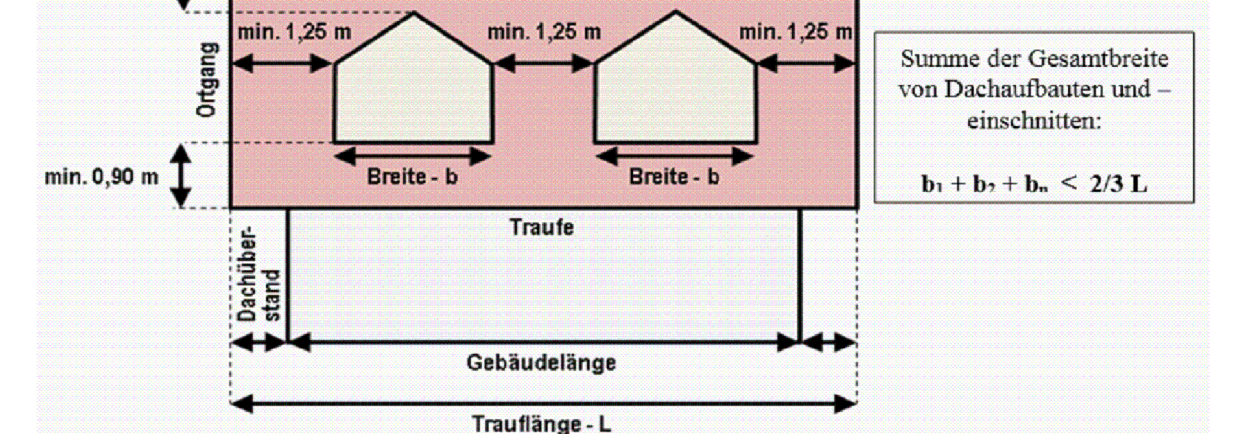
Abmessungen zulässiger Dachgauben (hier Beispiel: Satteldach)
